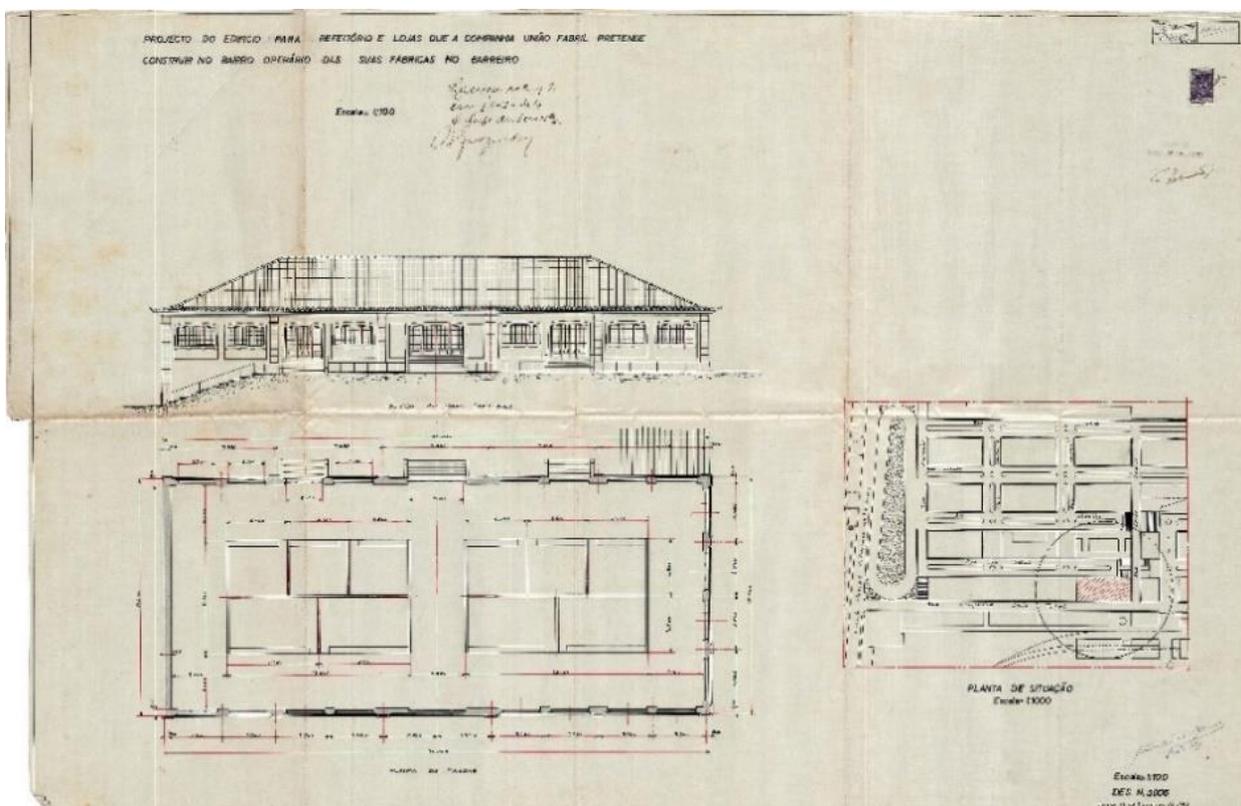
Conjunto de Plantas e Alçado do Refeitório e Lojas que a CUF construiu no Bairro Operário
